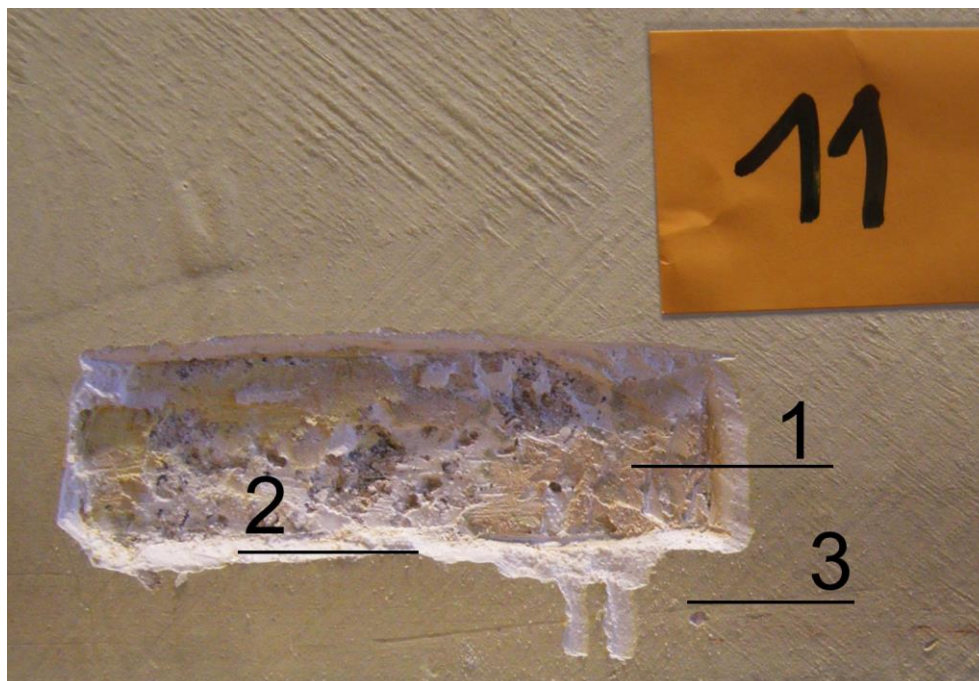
Odkrywka nr.6 -tynk w hallu na parterze Widoczne warstwy;
